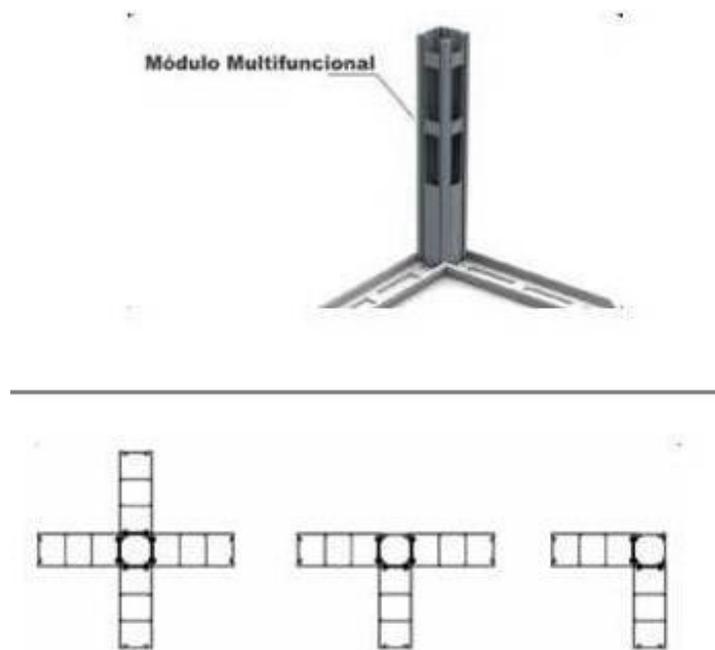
Esquema do perfil multifuncional, posicionado no encontro entre paredes (planta)
